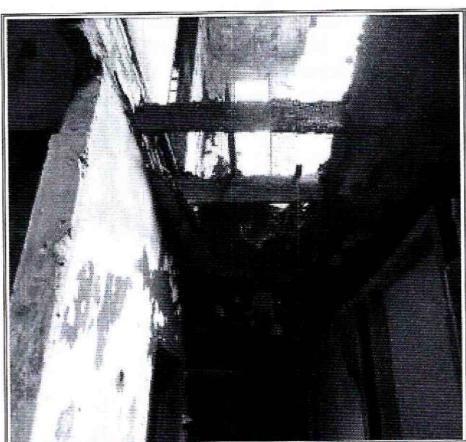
Afectación estructura de entrepiso en madera predio de la Carrera 24 D No. 17 - 19 Sur
